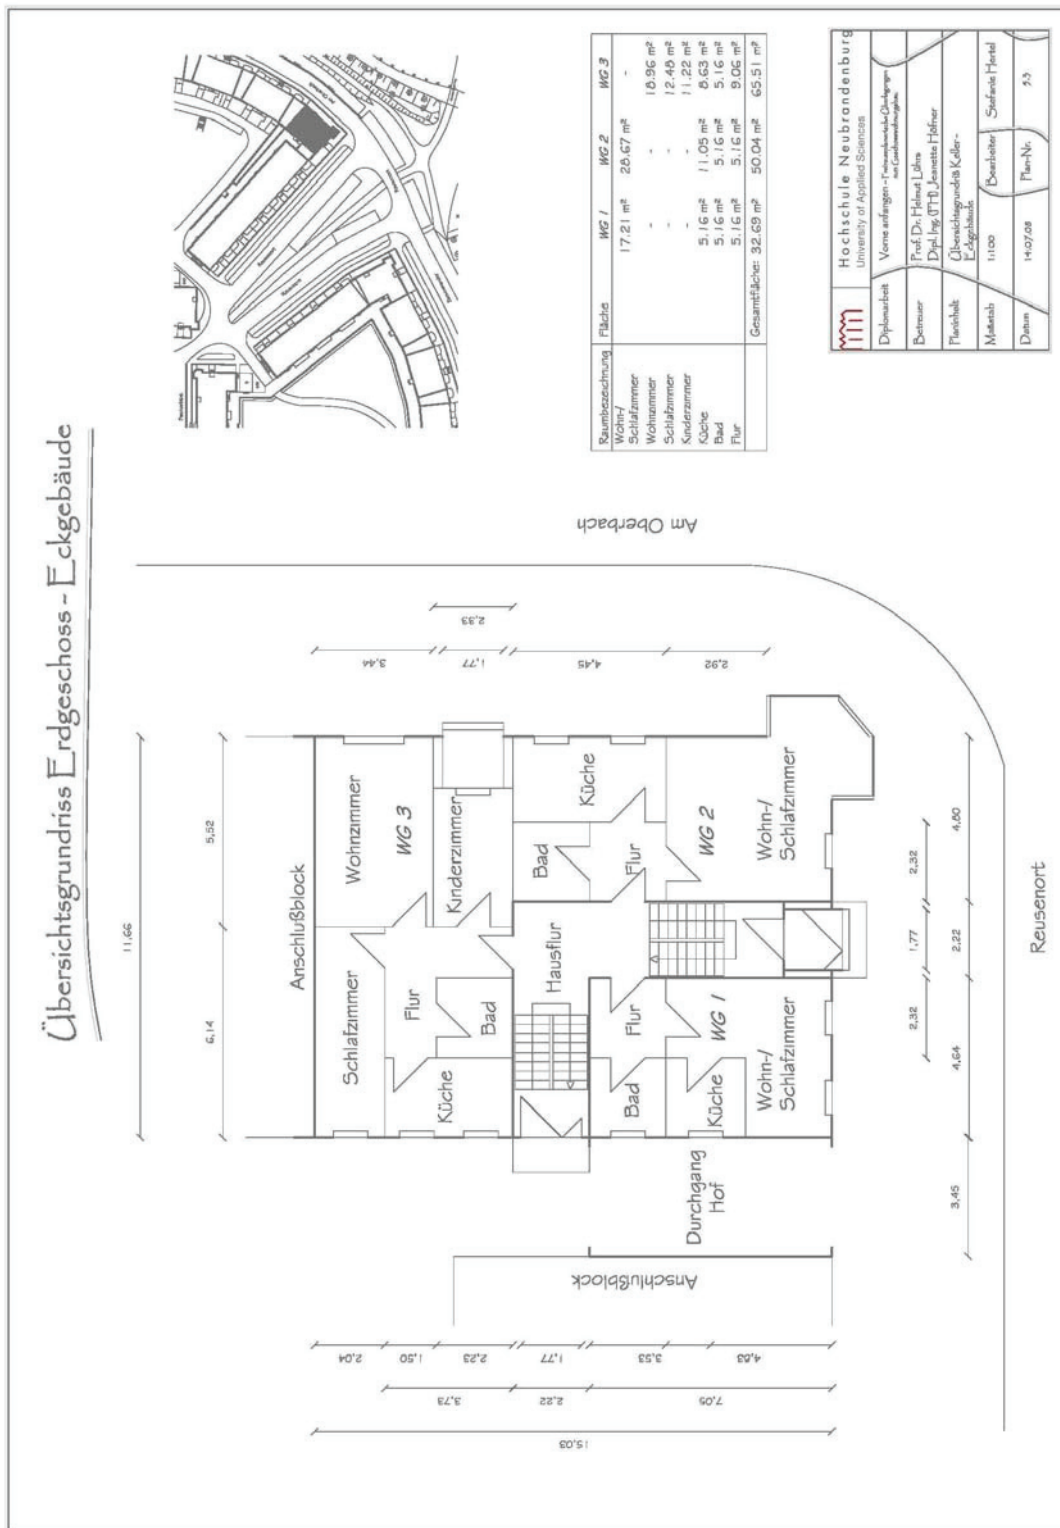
Übersichtsgrundriss des Erdgeschosses der Eckgebäude
